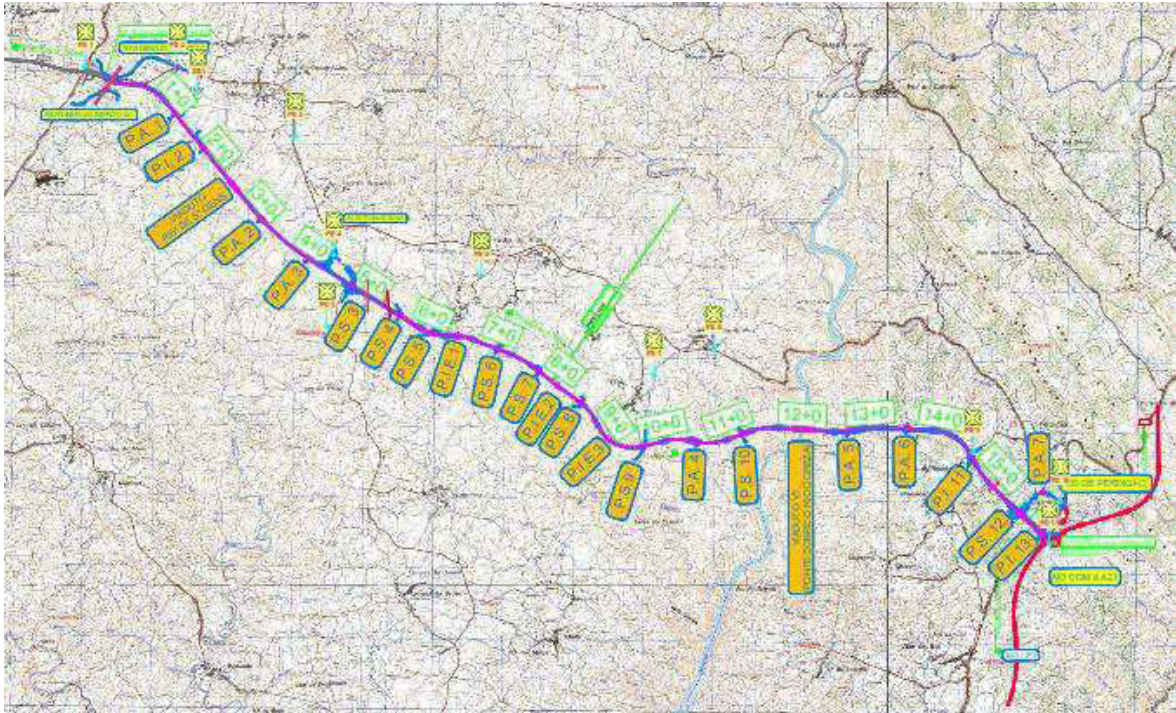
Planta do traçado geral, Pinhal Interior - Lote 7 [3] – adaptado
